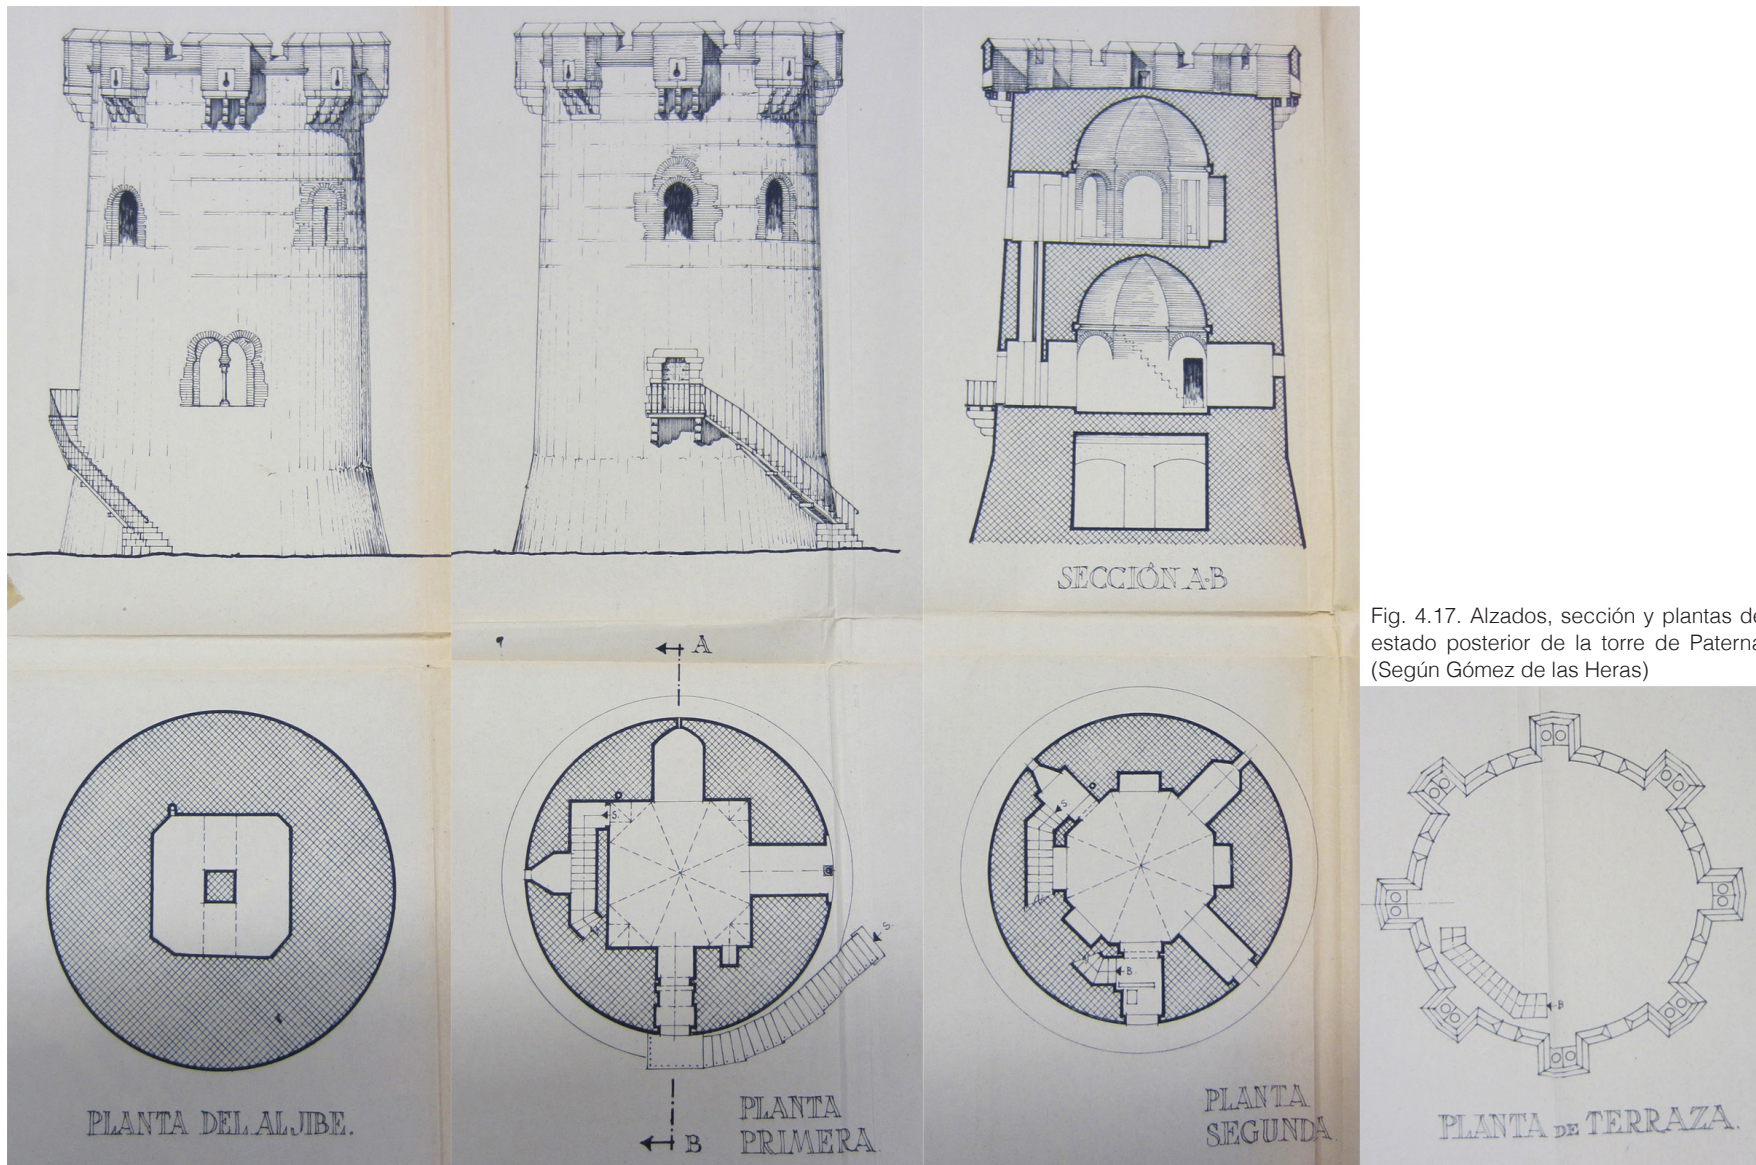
Alzados, sección y plantas del estado posterior de la torre de Paterna. (Según Gómez de las Heras)
